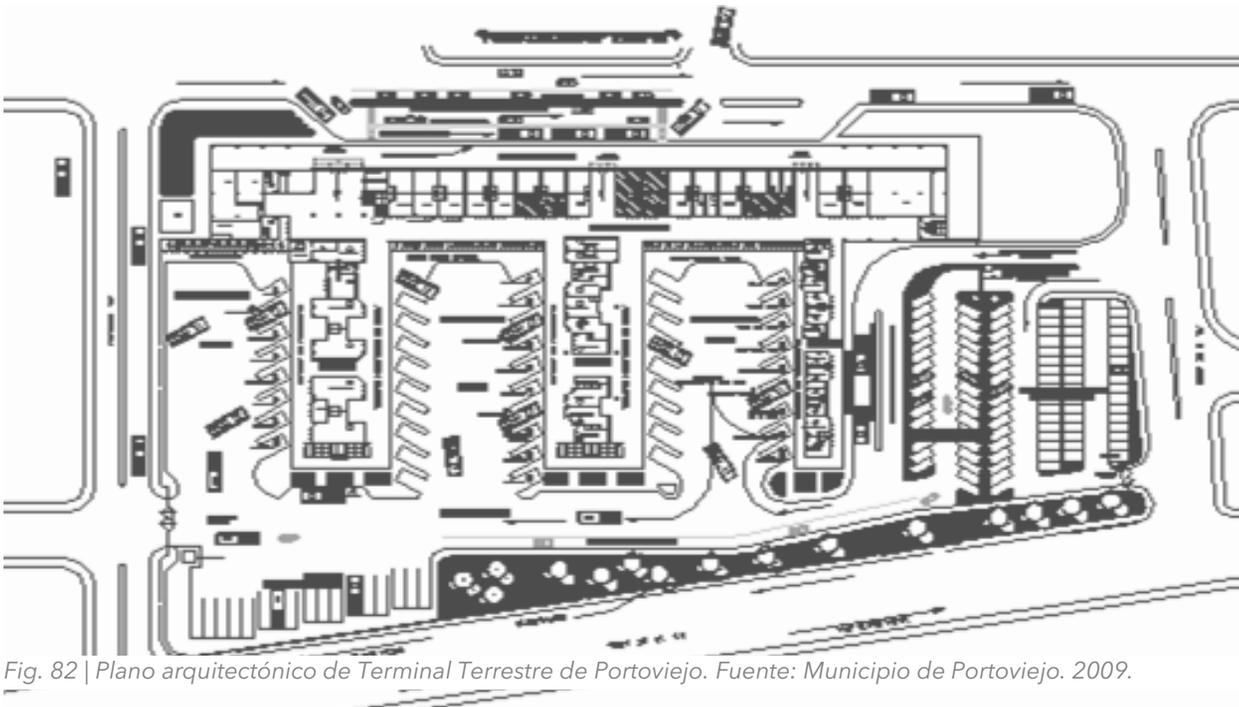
| Plano arquitectónico de Terminal Terrestre de Portoviejo. Fuente: Municipio de Portoviejo. 2009.
